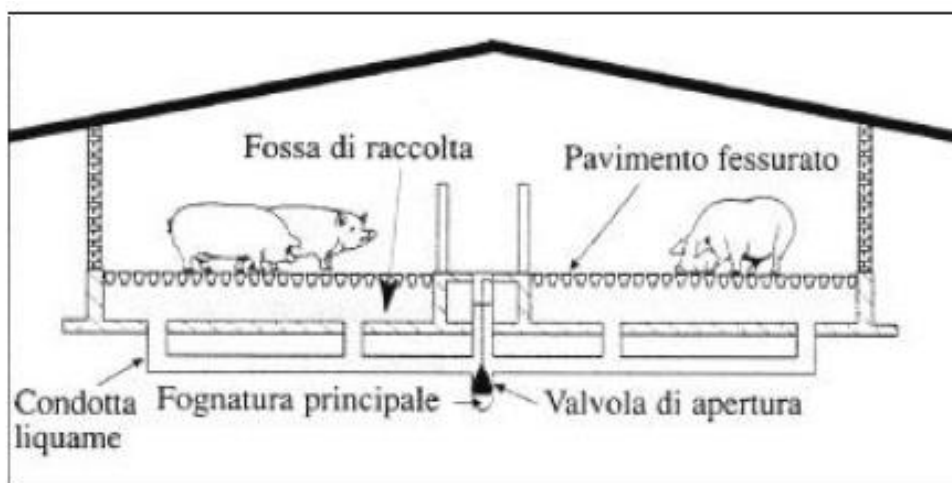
Schema di una porcilaia con pavimento in PTF e sistema vacuum
